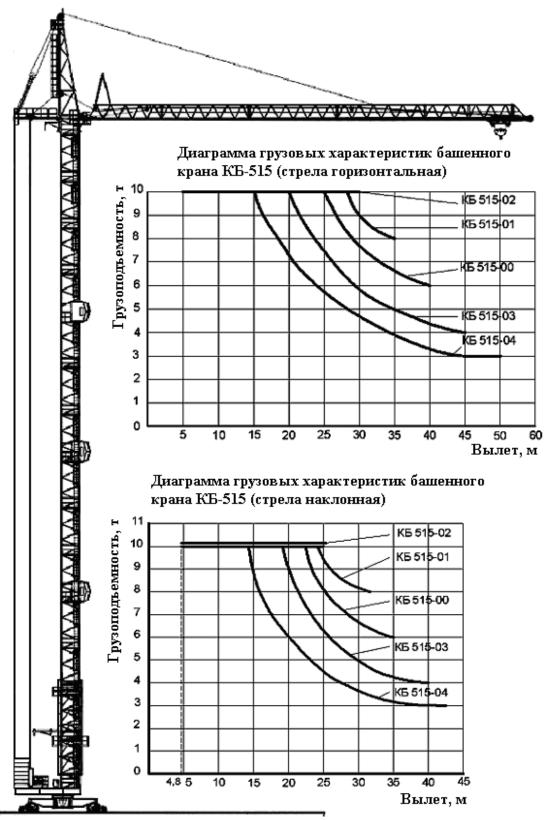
Башенный кран КБ 515 для строительства зданий повышенной этажности
